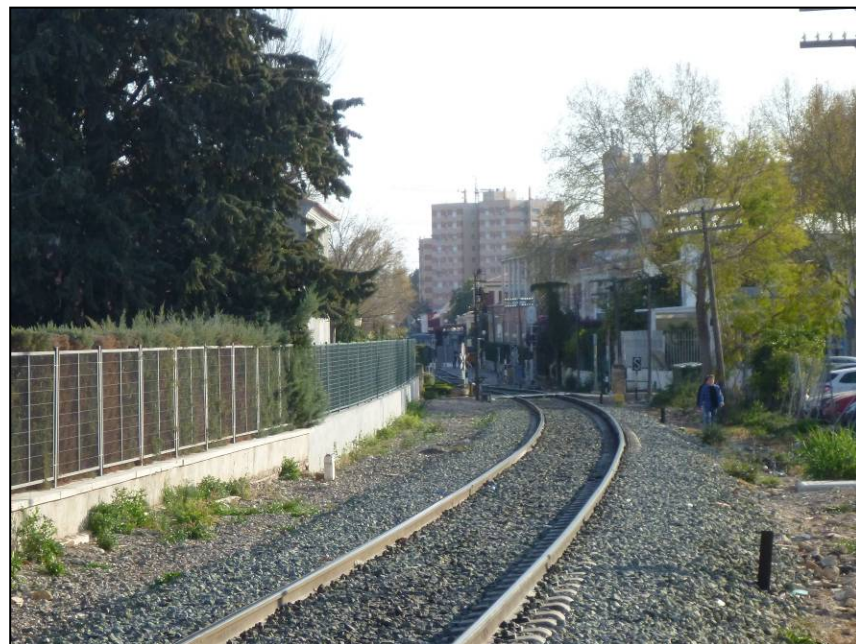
Paso a nivel de Ramón y Cajal visto desde Fajardo el Bravo.
